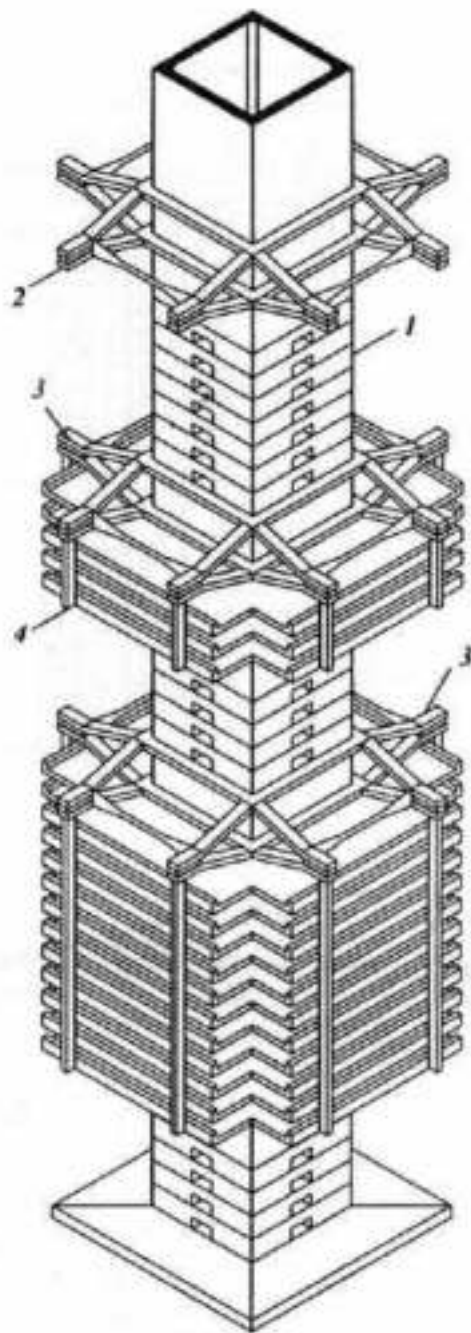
Будівля із перекриттями, підвищеними до консольних ростверсів:
